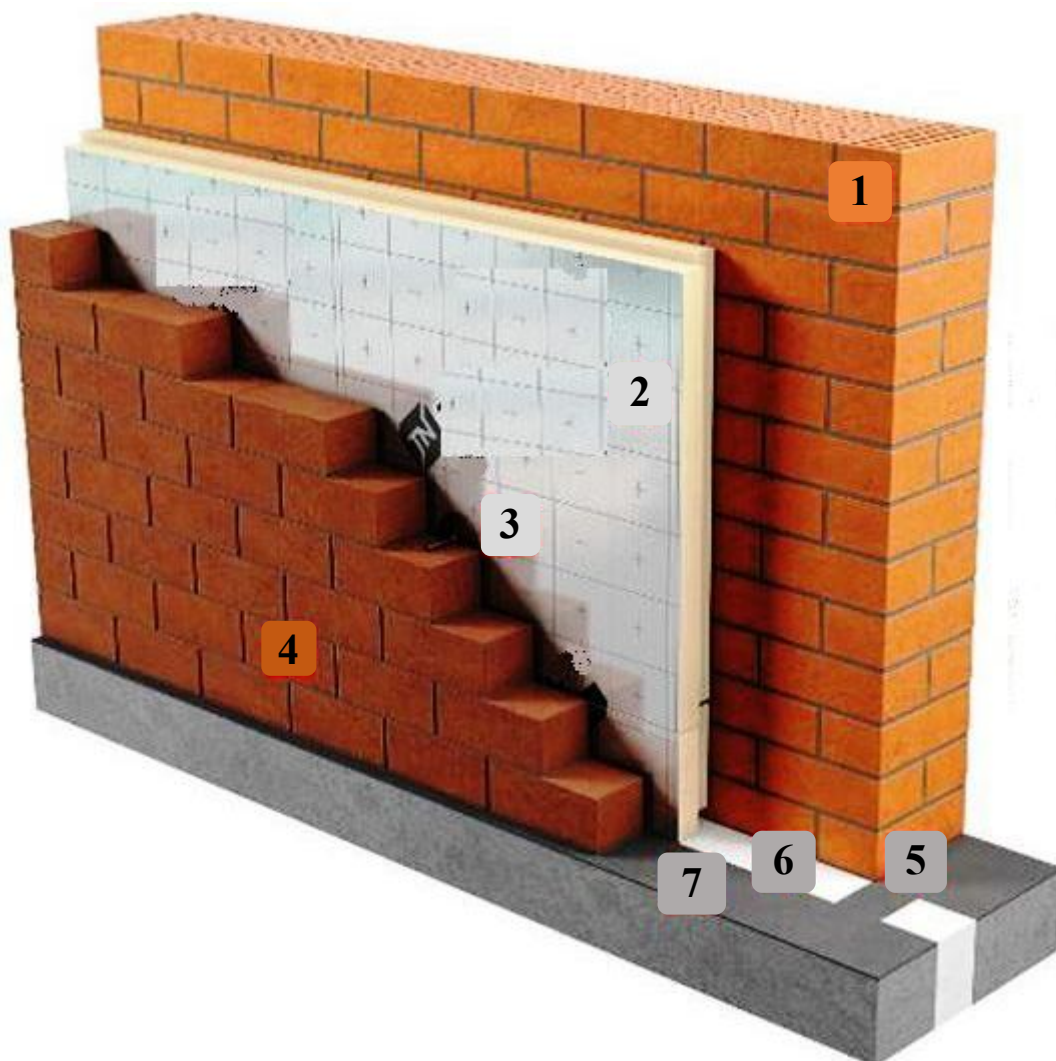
Система утеплення з облицюванням із цегли: 1 – несуча стіна; 2 – плити теплоізоляційні; 3 – гнучкі зв'язки; 4 – цегла облицювальна; 5 – гідроізолювальне відсічення; 6 – термовкладиші; 7 – опорне перекриття
